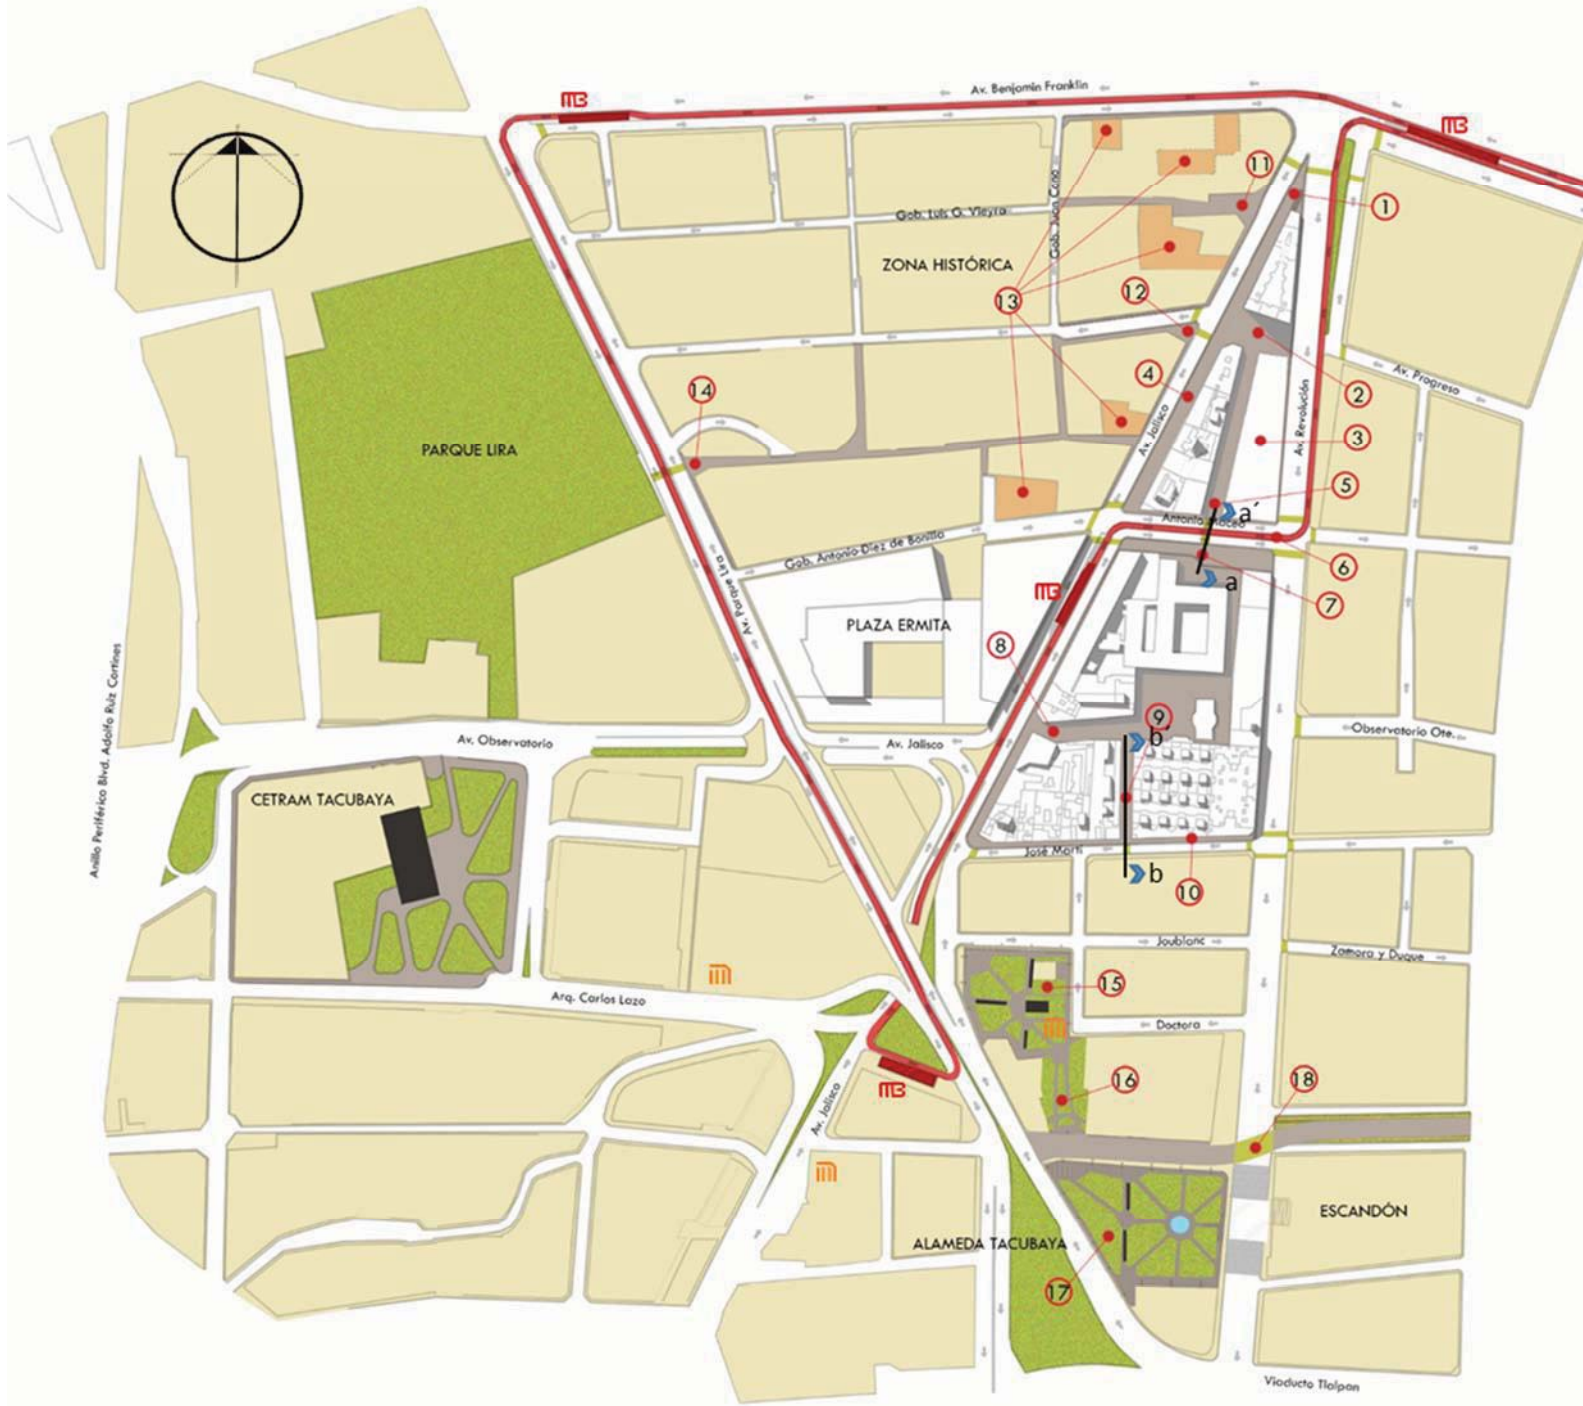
Planta de conjunto, Triángulo y Alameda de Tacubaya. Escenario 3, Opción 5. Elaboración propia.
